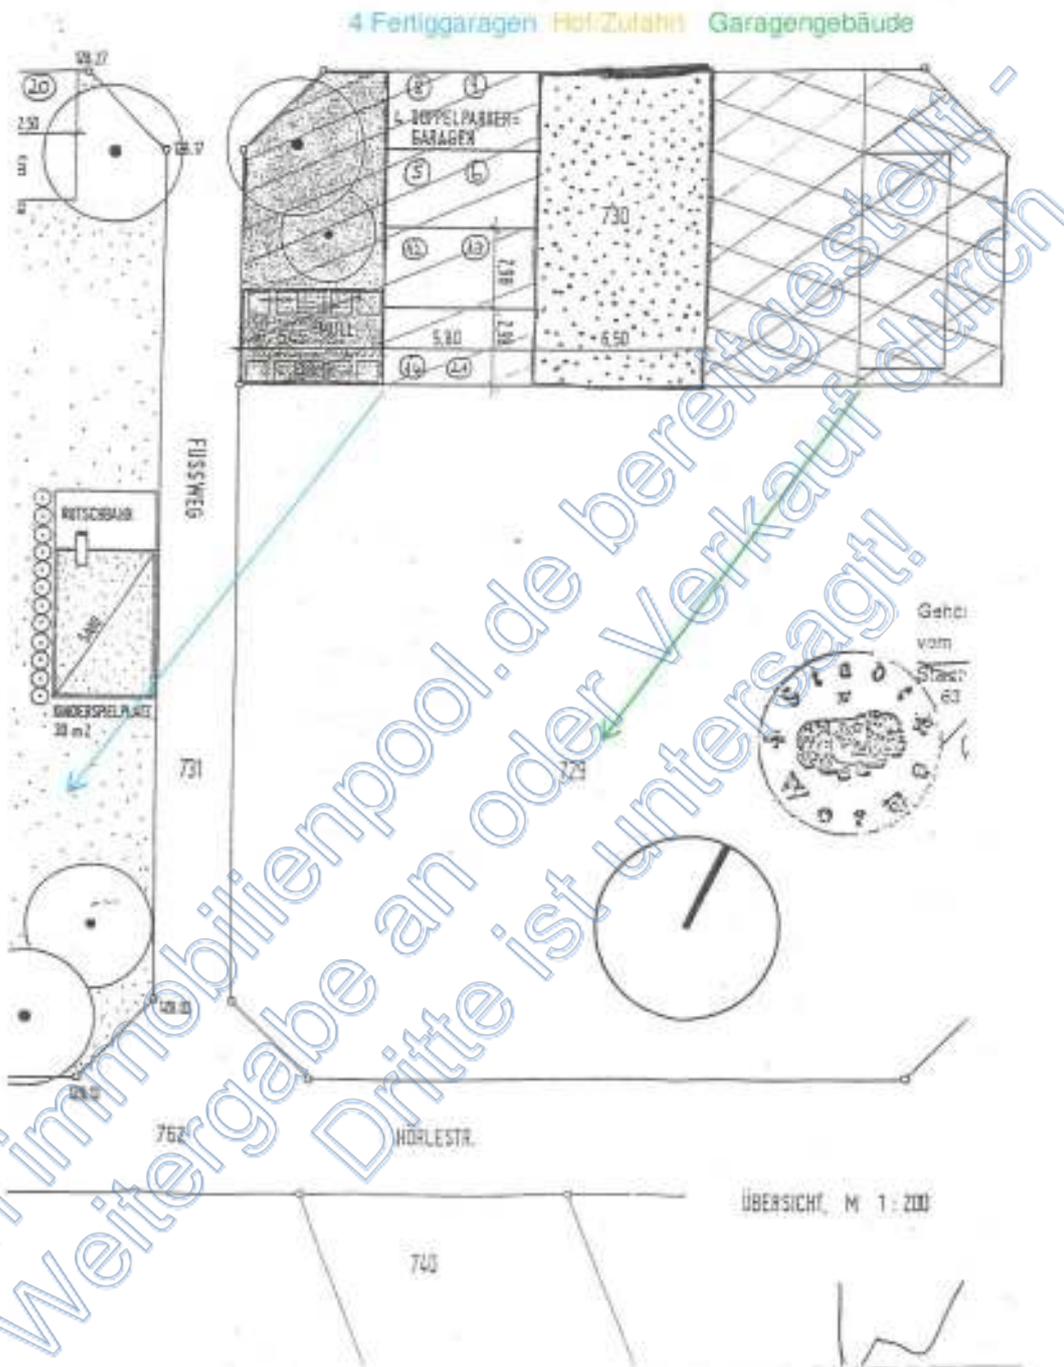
Plan zur Nutzungsvereinbarung (aus Grundakte)
